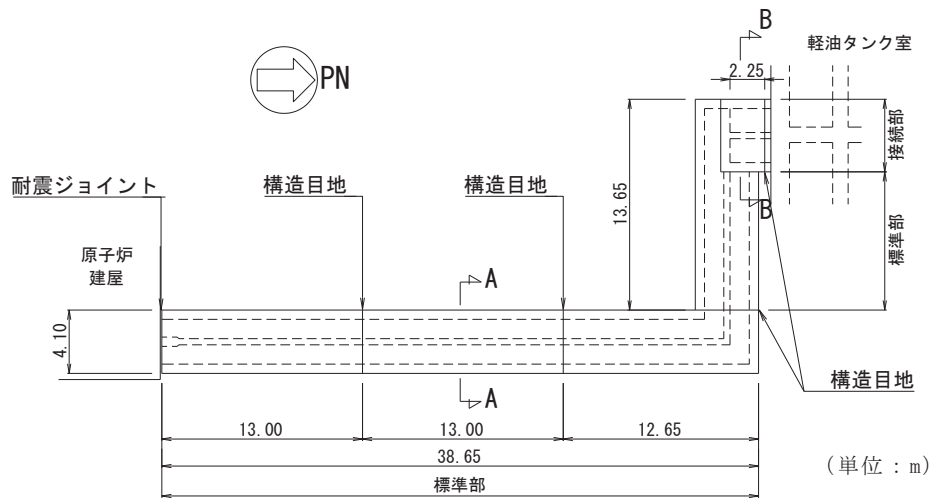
軽油タンク連絡ダクト平面図（詳細）
